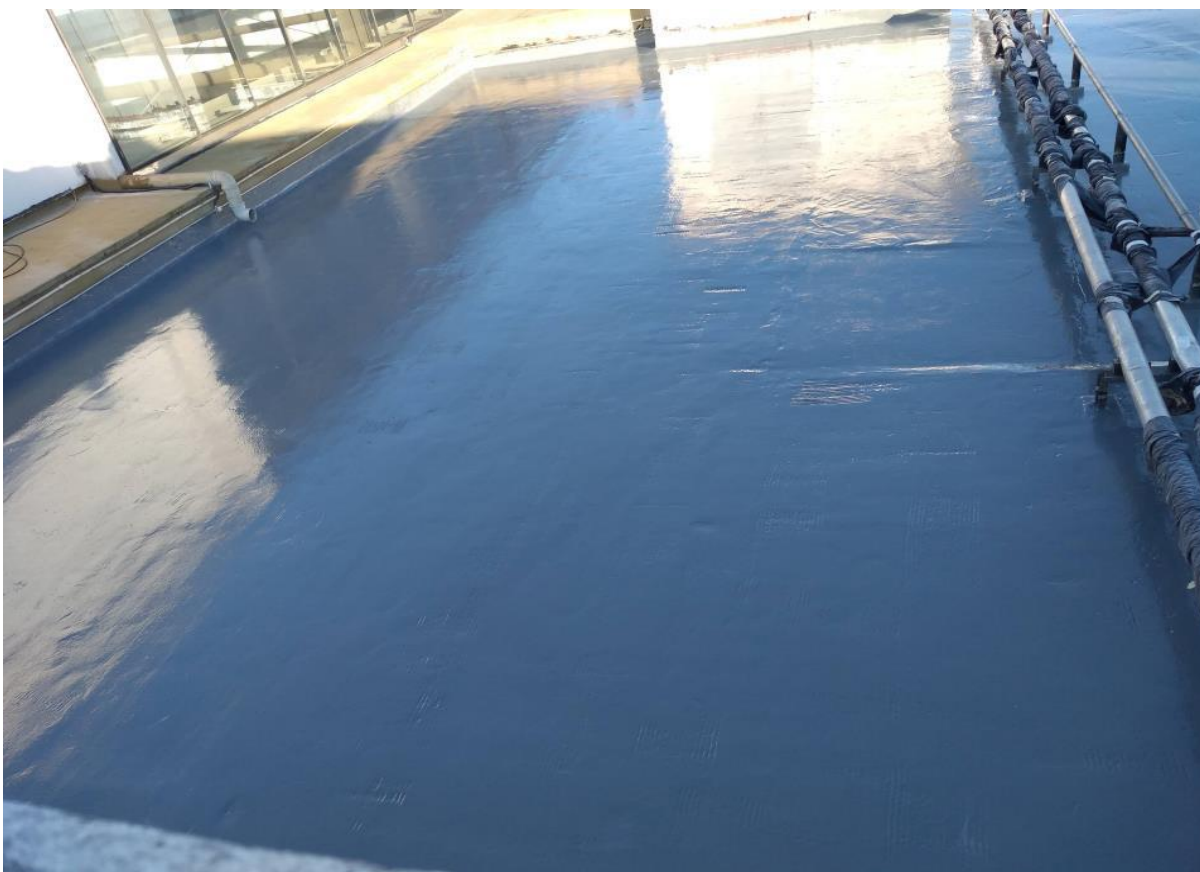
Laje do edifício A impermeabilizada com membrana de poliuretano.
